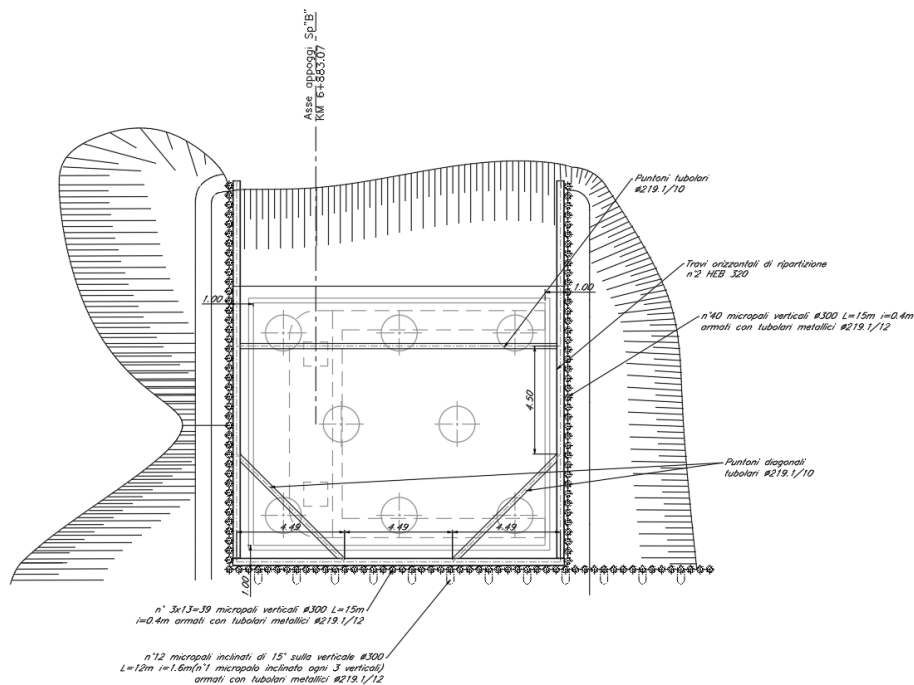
Pianta Opere Provisionali Spalla B
